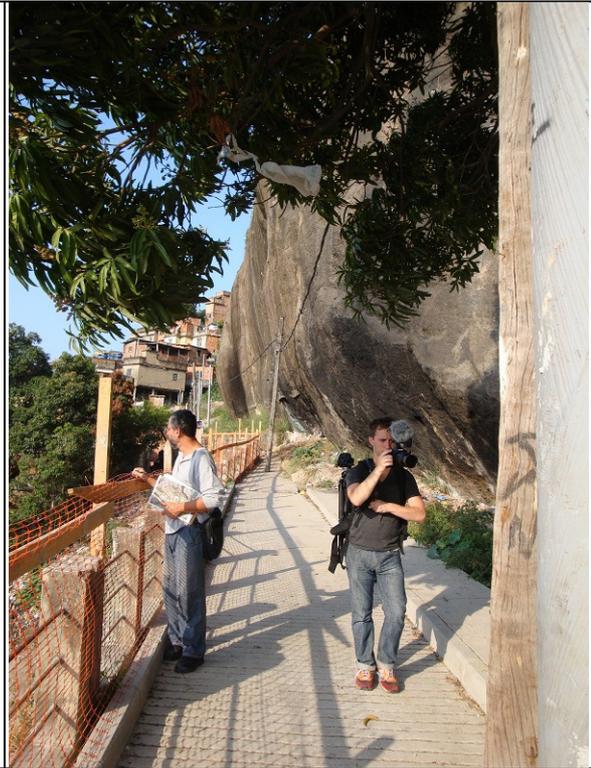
e 66 - Rua da Grotta/escarpa a montante
